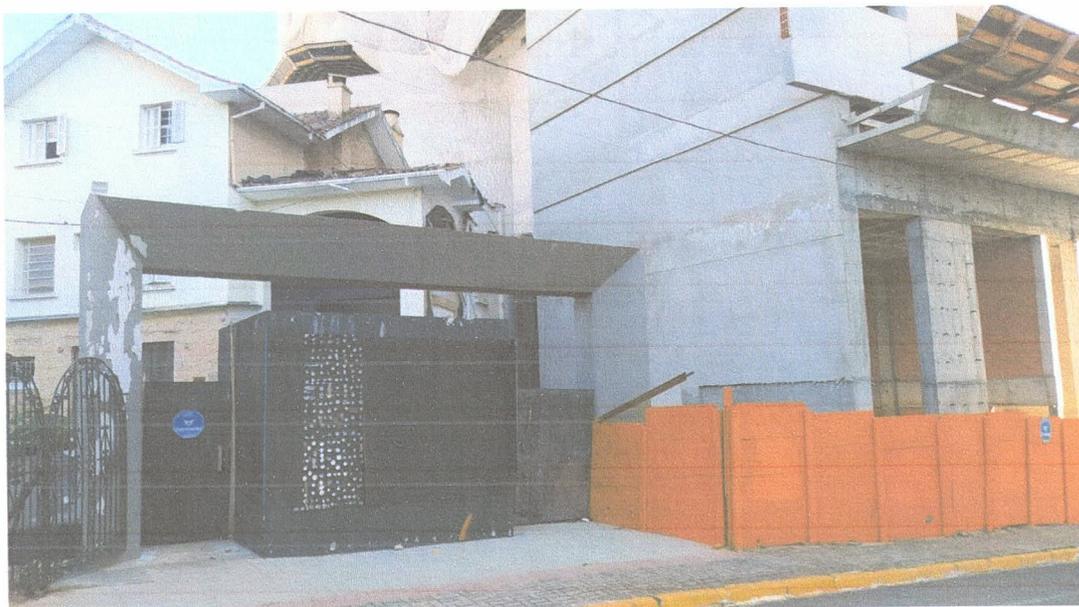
Vista externa da fachada Rua Marecham Bormann
